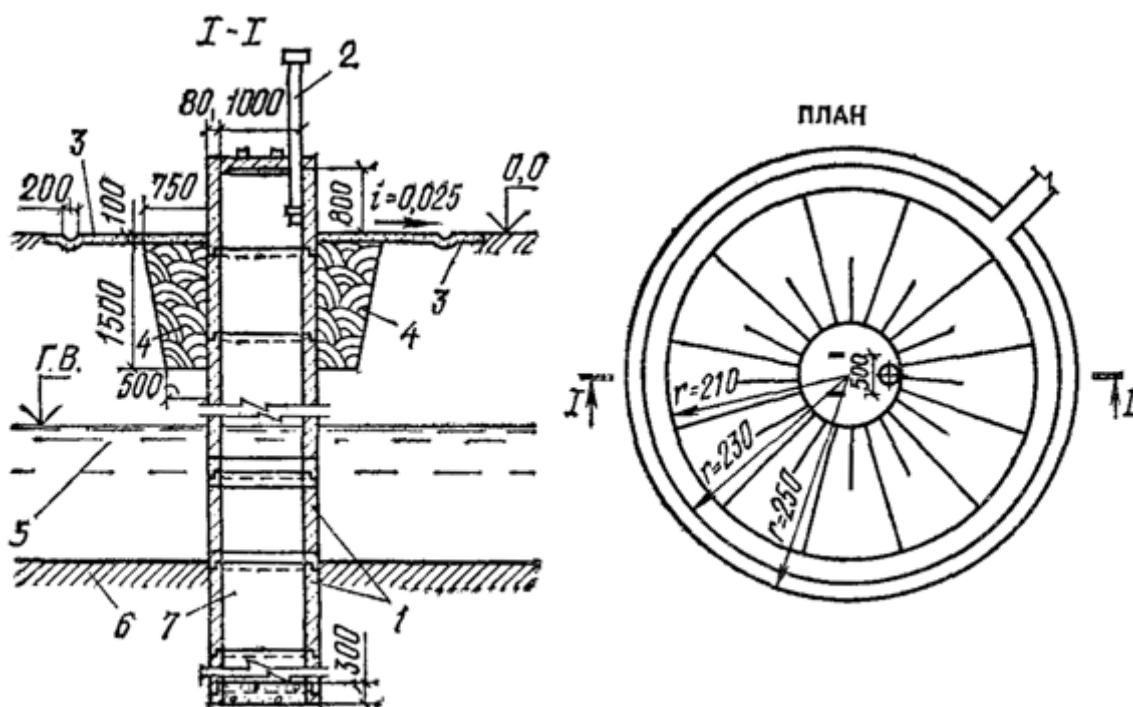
Схема совершенного шахтного колодца из сборных железобетонных колец: 1 – кольца; 2 – вентиляционная труба; 3 – щебеночное крепление; 4 – глиняный замок; 5 – водоносный грунт; 6 – водоупорный грунт; 7 – зумпф
